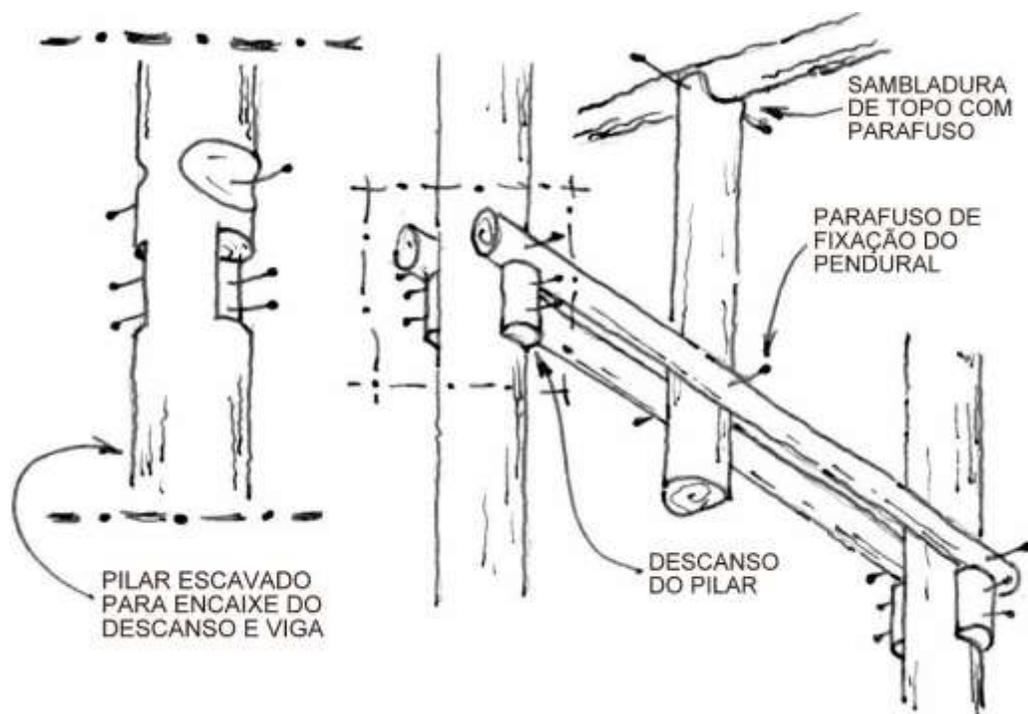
Desenho do sistema de encaixe pilar-viga de Balbina. Croqui: CANTALICE II.
